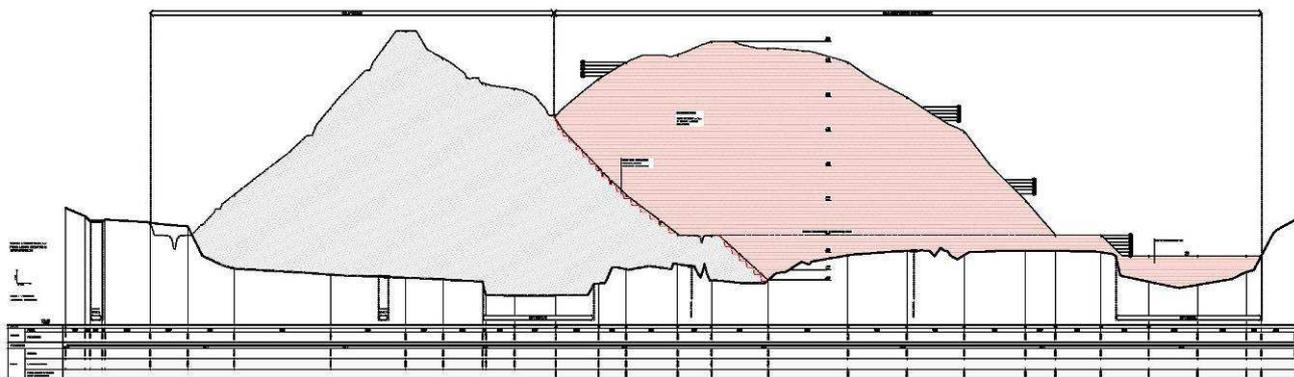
Sezione longitudinale con il Primo Ambito d'Implementazione
